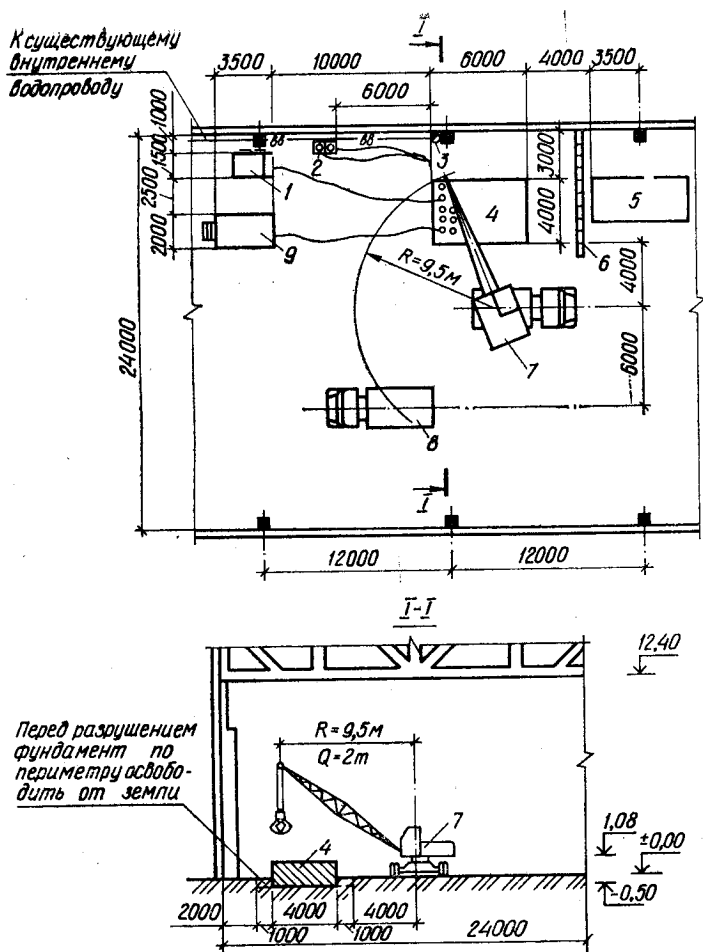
Схема разрушения железобетонных фундаментов при помощи установки ЭГУРН:
